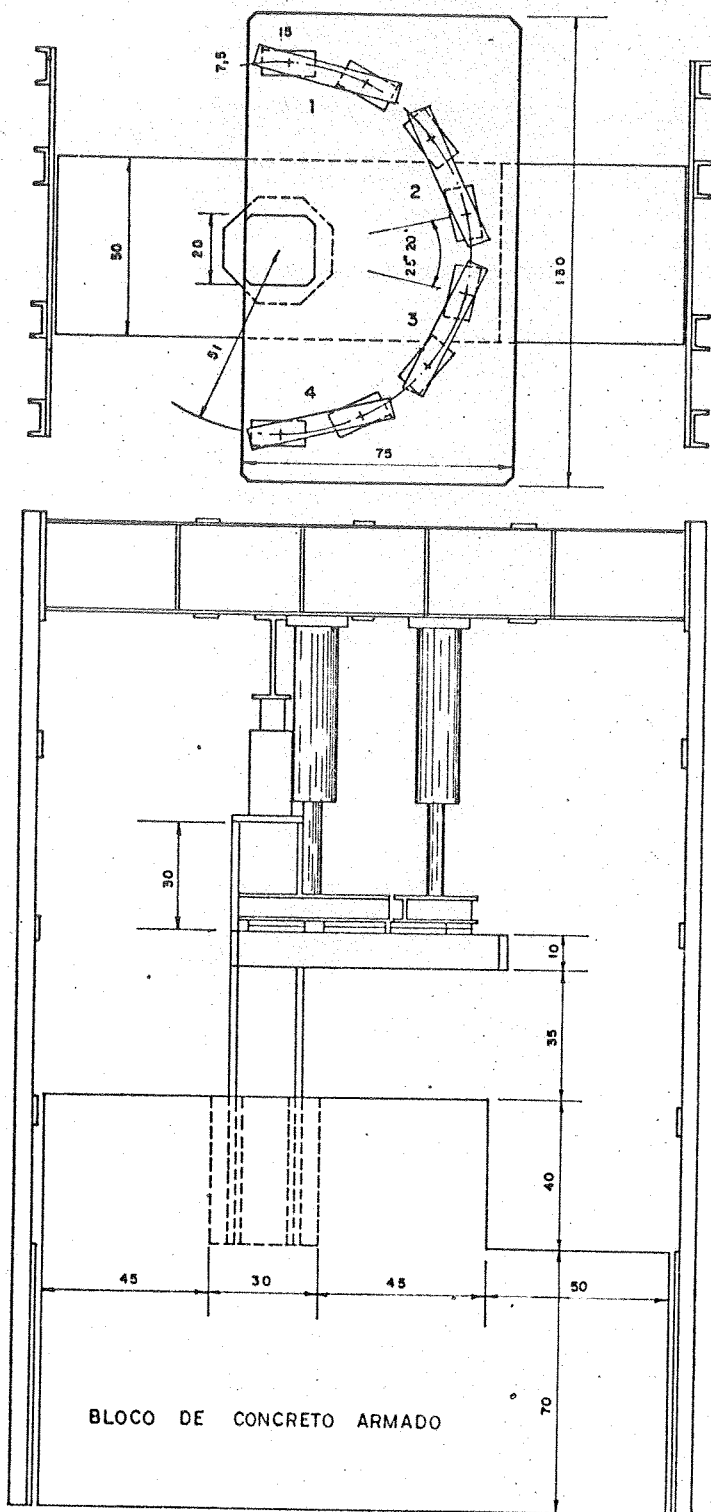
ESQUEMA DE ENSAIO UTILIZADO
